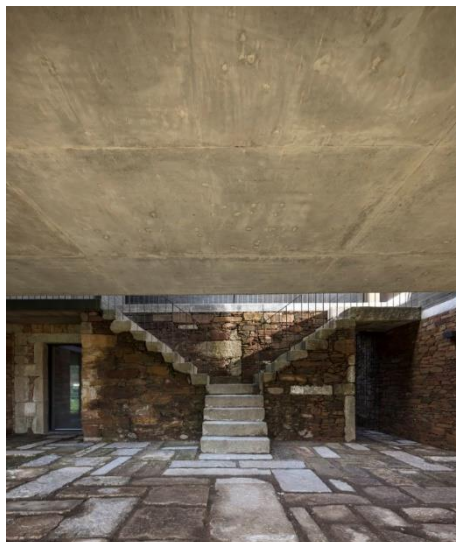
RPFV House, adição de construção nova a pré-existência
